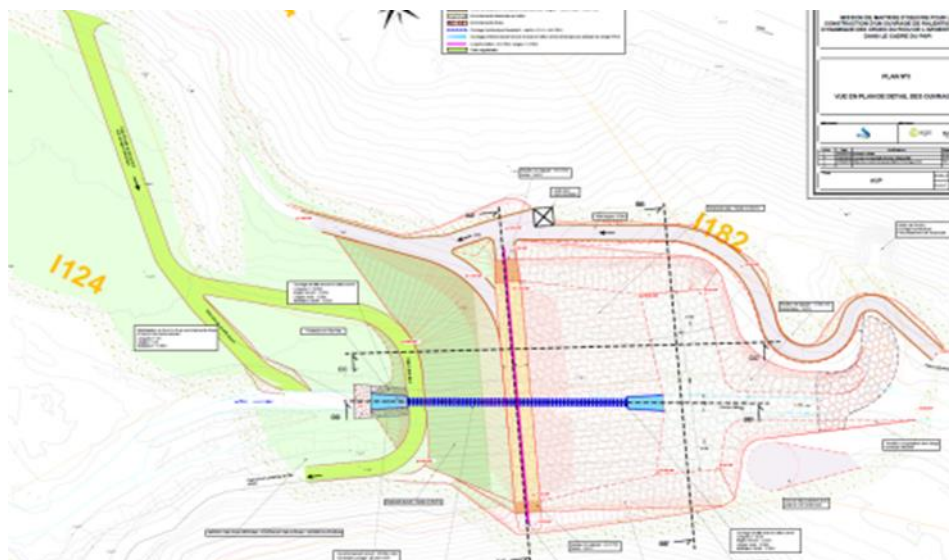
Vue en plan de détails des ouvrages (AVP juillet 2018, source EGIS)
